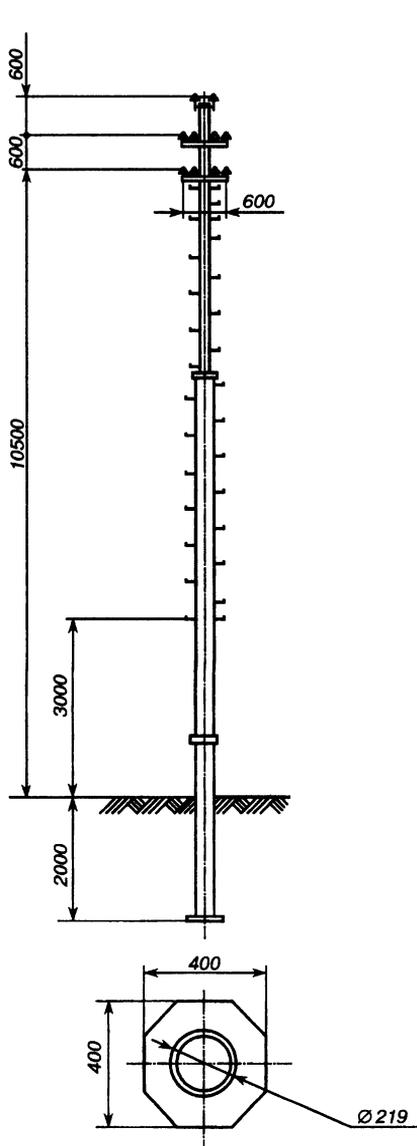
Переходная железобетонно-металлическая опора ВЛ 0,4 кВ
